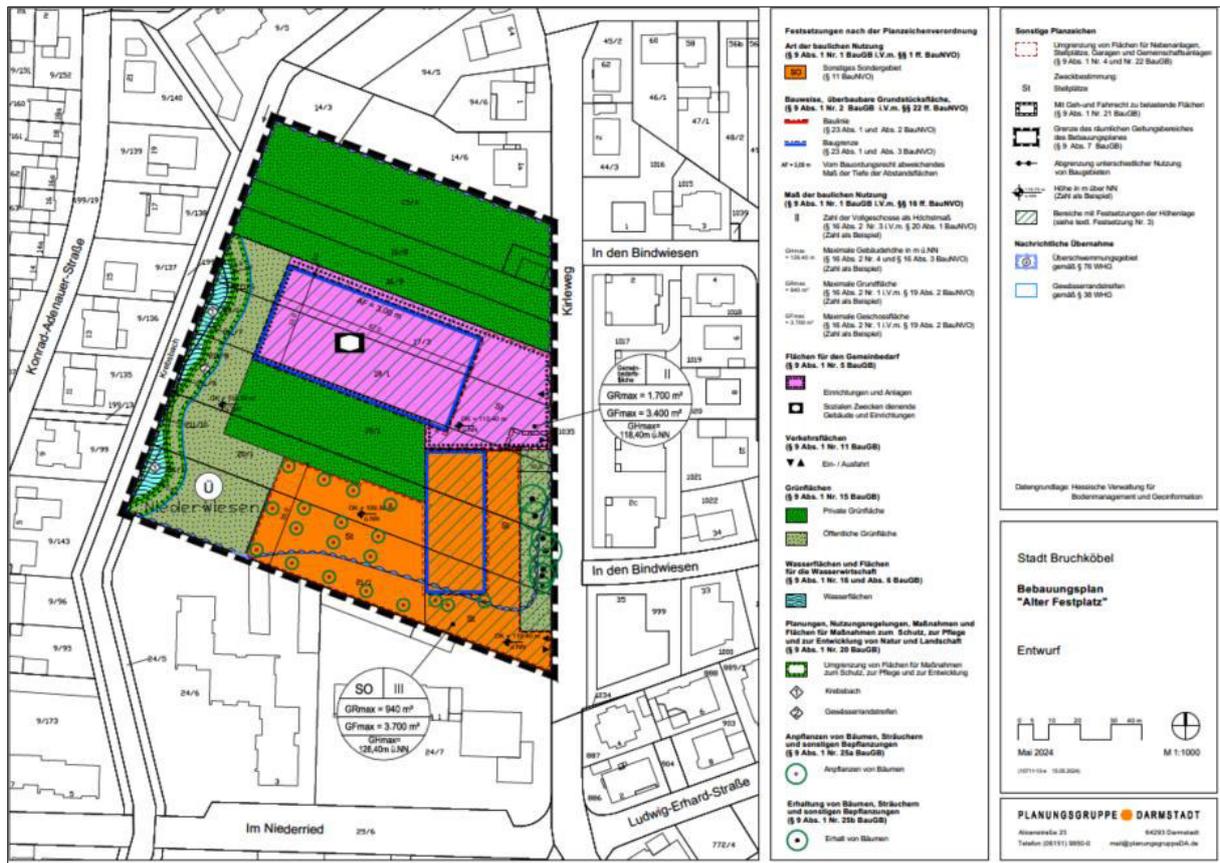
Entwurfsplanung zum B-Plan (Vorentwurf Planungsgruppe Darmstadt, Stand Mai 2024)
